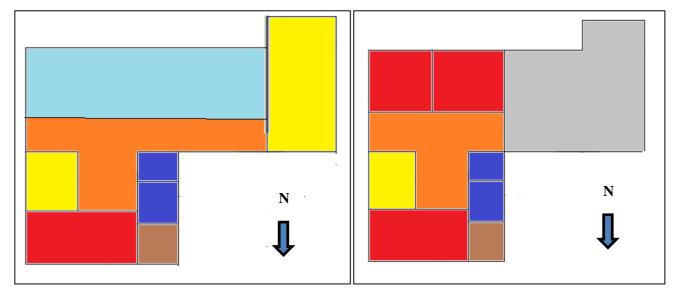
type 1 plan 1^{er} étage F5 duplex
